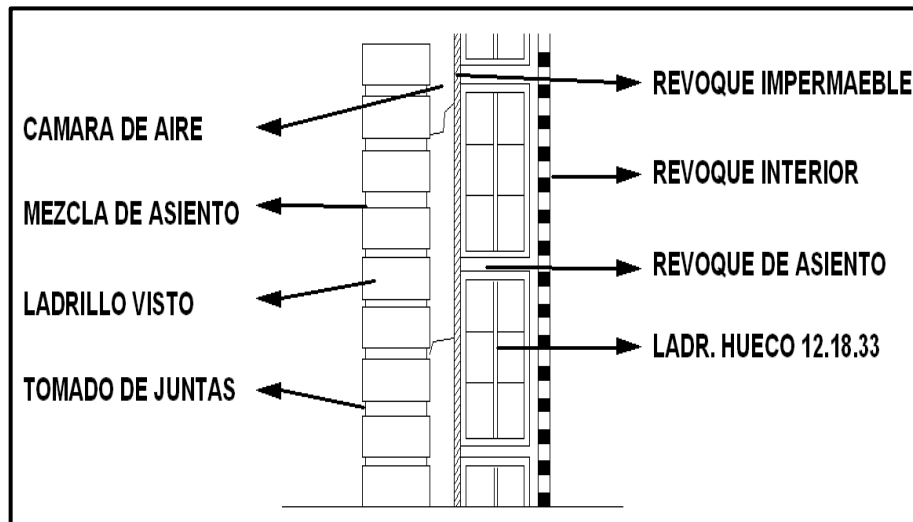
Muro con cámara de aire. Fuente: <http://www.sistematicasa.com.ar>
